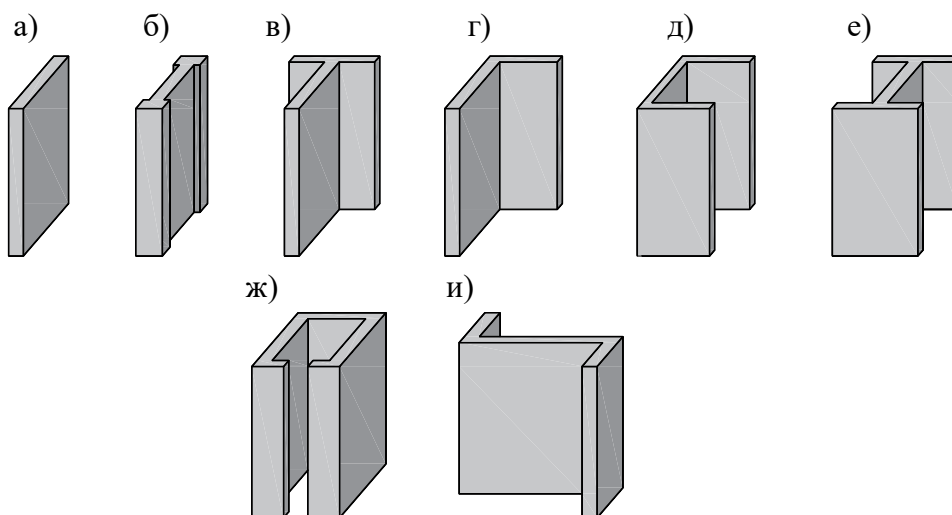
Примеры стен с простыми и сложными поперечными сечениями:
